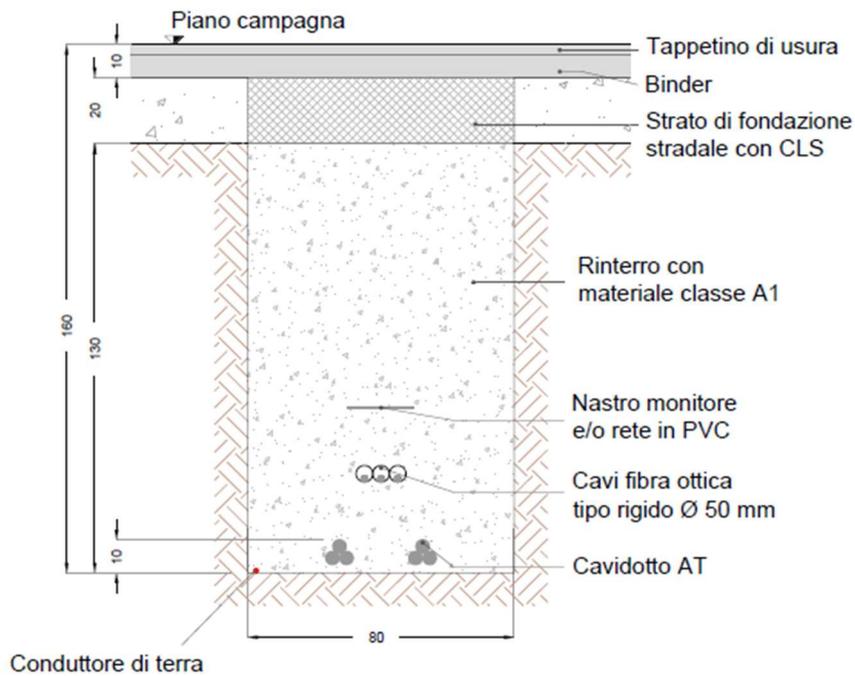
Sezione tipo cavidotto AT una terna su strada asfaltata
